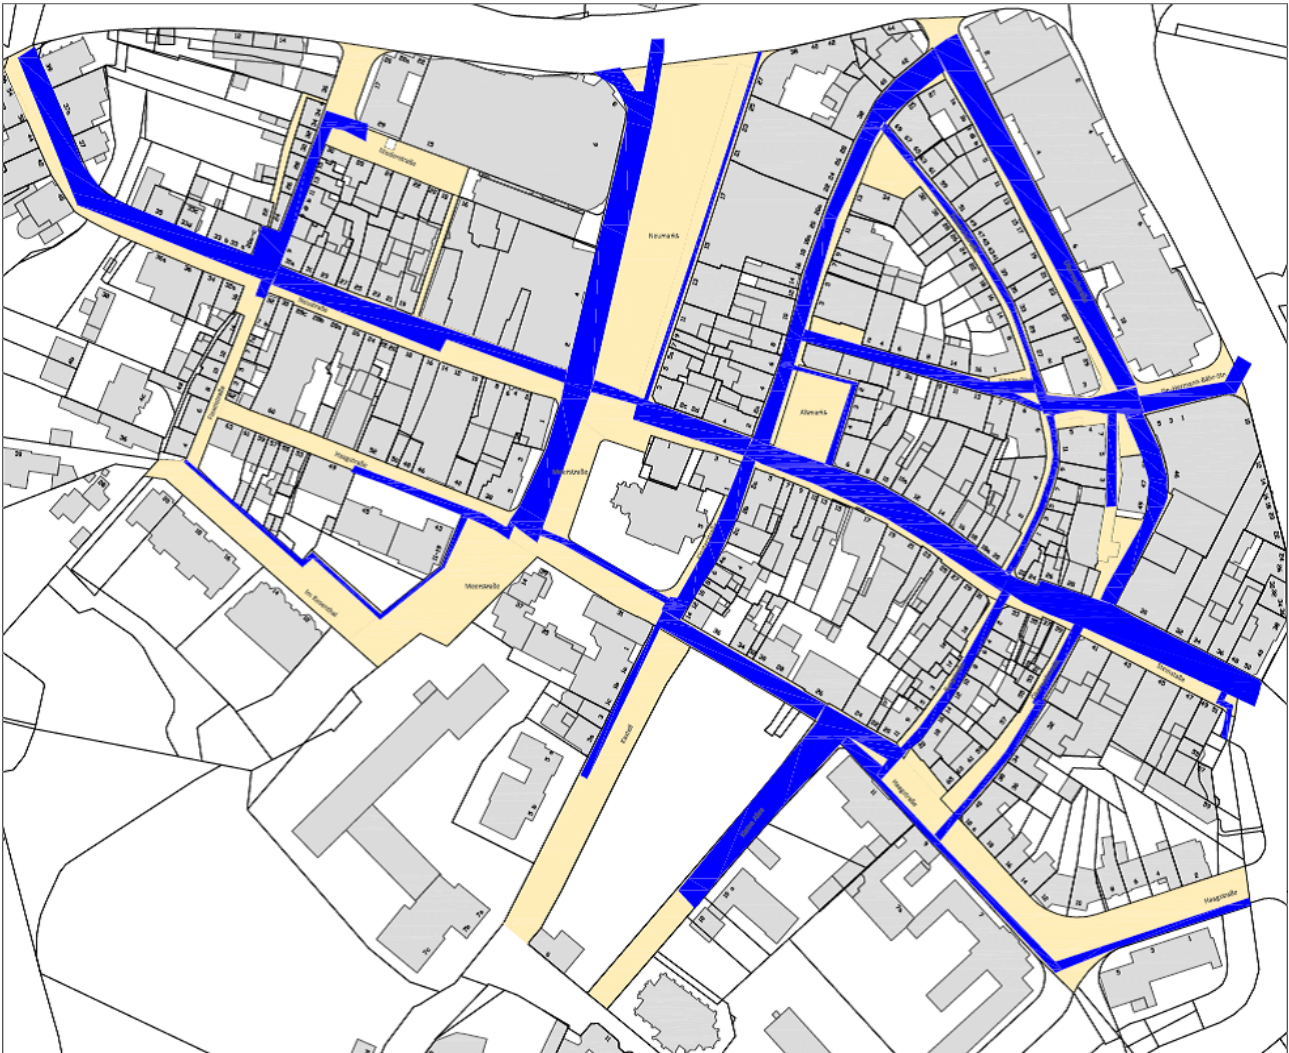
Baugruben (blau) und Baurestflächen (beige)
